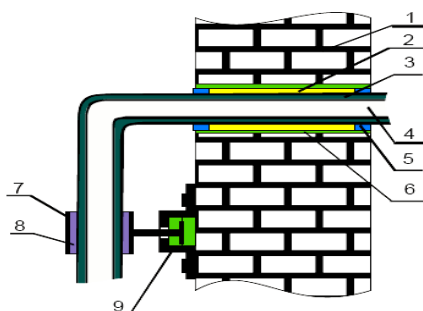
Схема прокладки инженерных коммуникаций. 1 – стена; 2 – упругая прокладка; 3 – вибродемпфирующий материал; 4 – трубопровод; 5 – невысыхающий герметик; 6 – гильза; 7 – монтажный кронштейн; 8 – прокладка из мягкой резины; 9 – виброизолирующее крепление.
